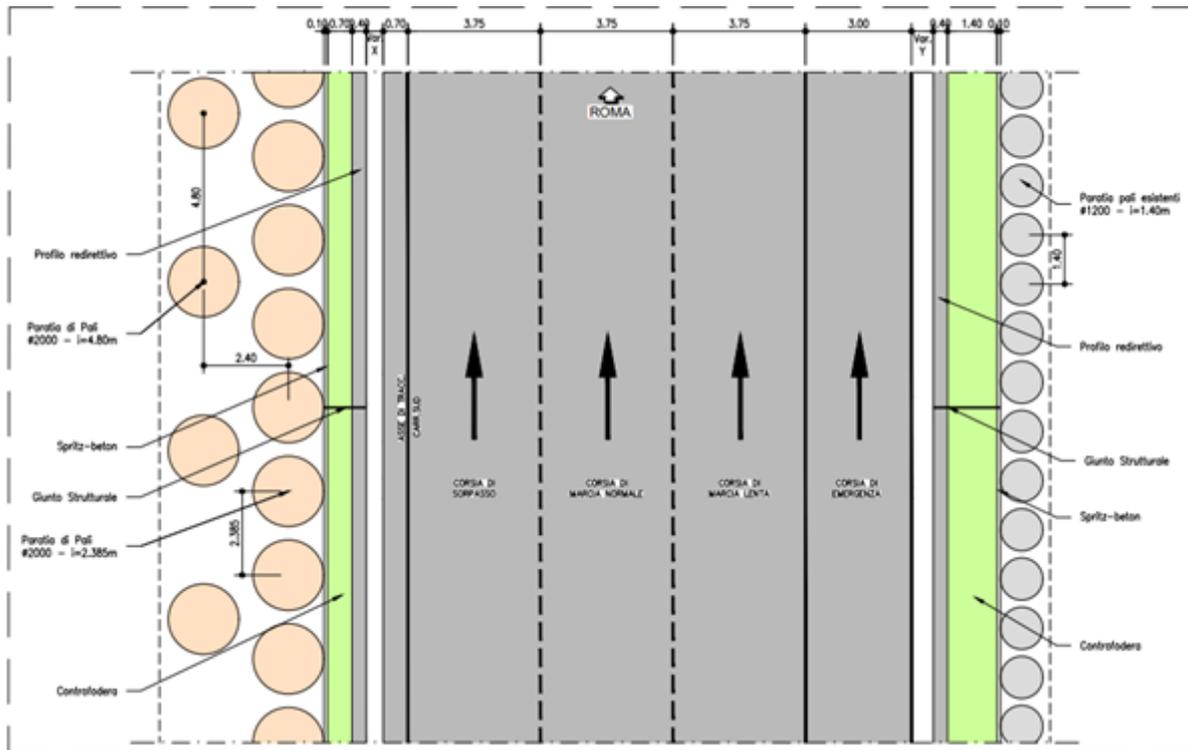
Pianta Concio Tipo Galleria Artificiale doppia fila di pali
